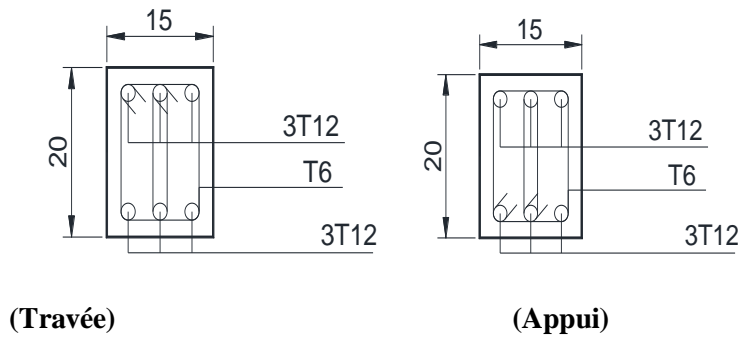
Ferrailage d'une poutre noyée secondaire 15x20cm (plan irrégulier en élévation)
